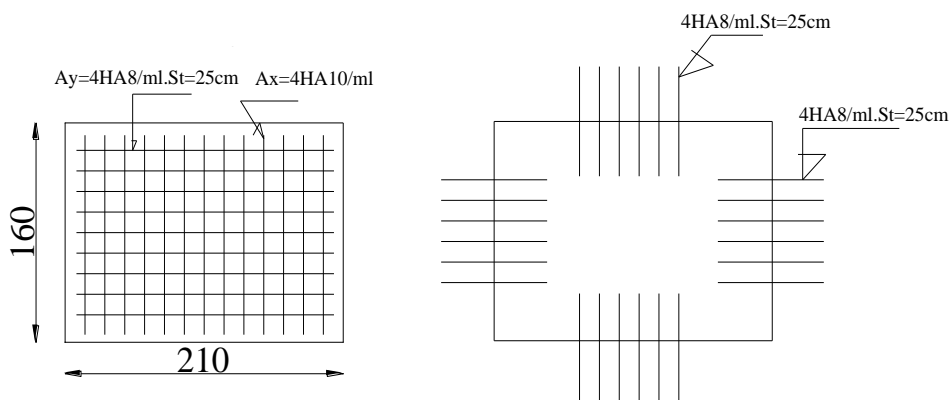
Schéma de ferrailage de la dalle du local machine.
